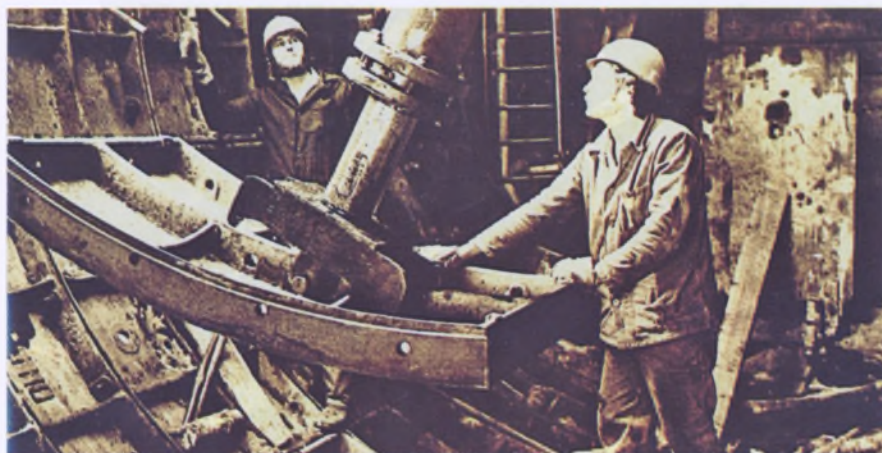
Монтаж тоннельной обделки из чугунных тубиков
